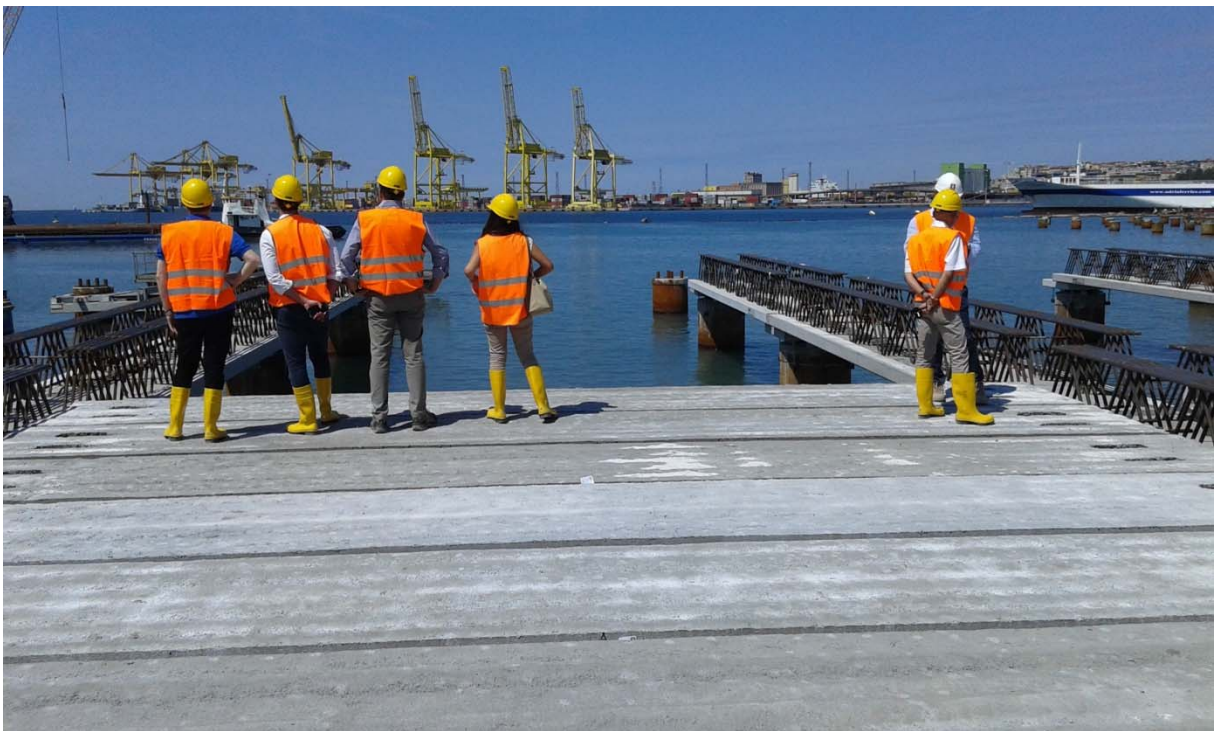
Realizzazione impalcato mediante elementi prefabbricati in c.a. e successivo getto in opera di solidarizzazione
